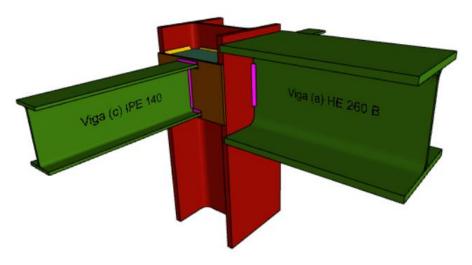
Unión pilares- vigas segunda planta. Fuente: CYPE 2019
